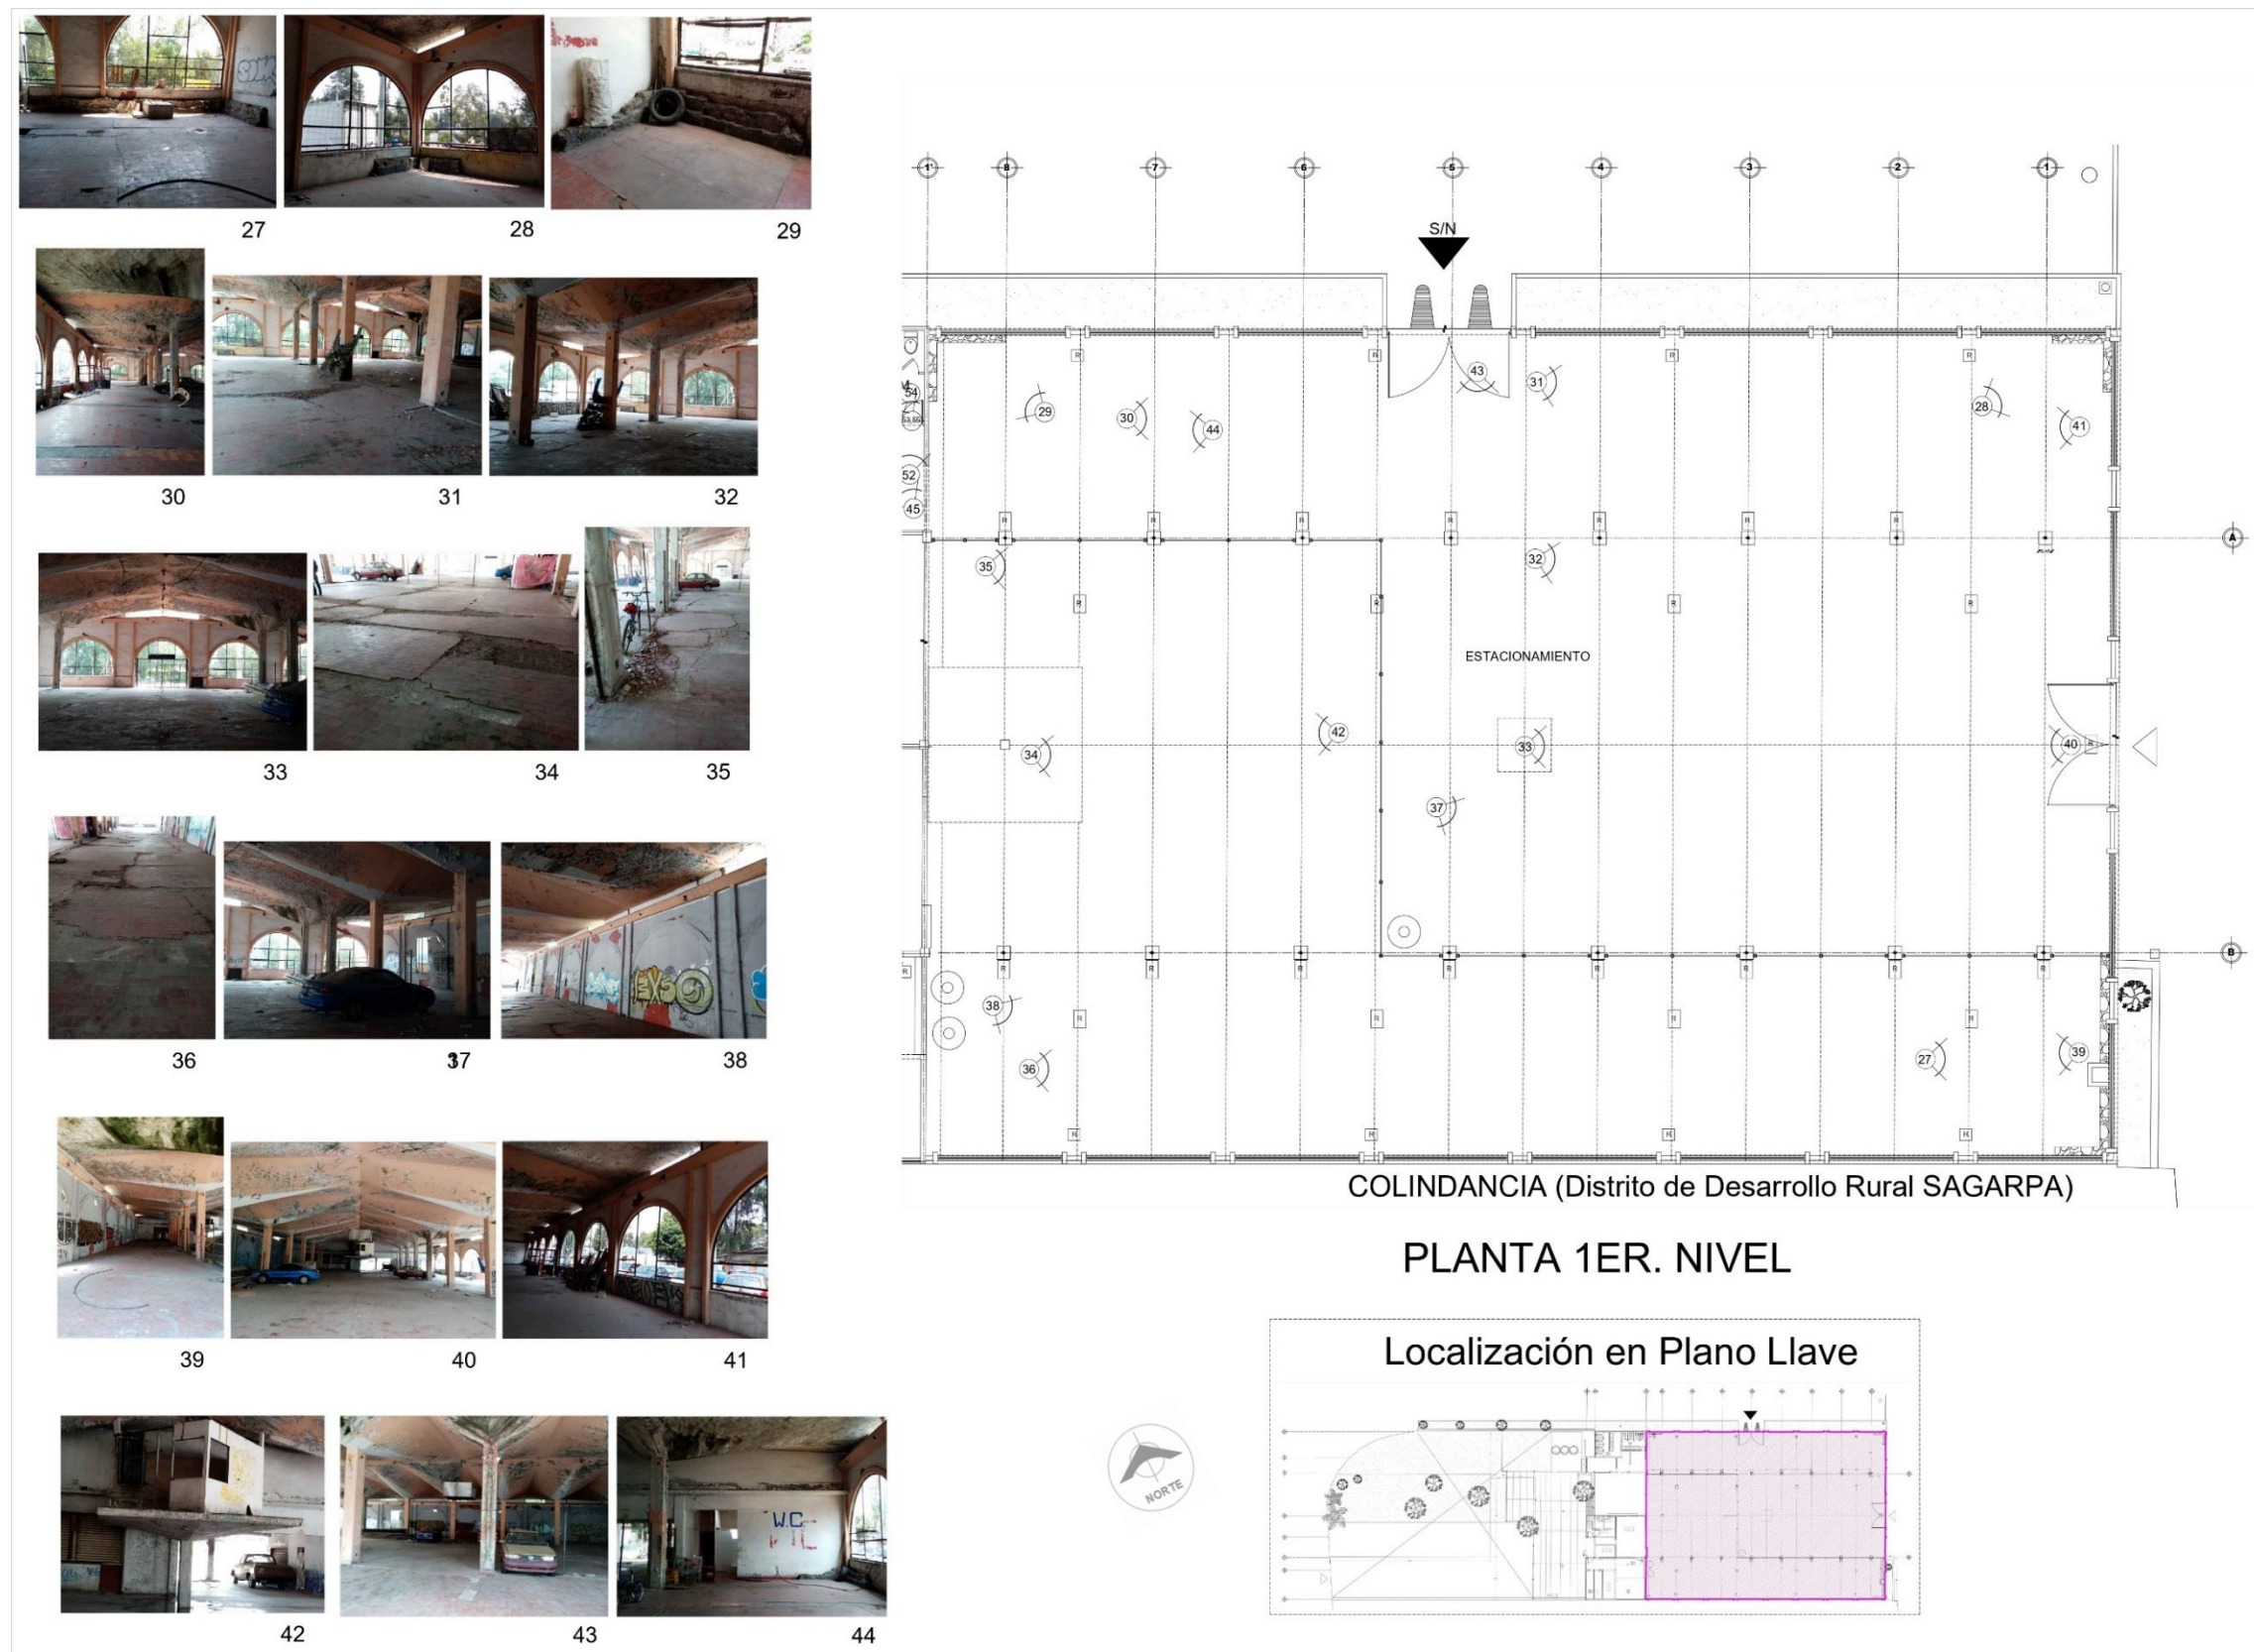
Reporte fotográfico de Construcción "A" (Martínez Andrea, 2020).
